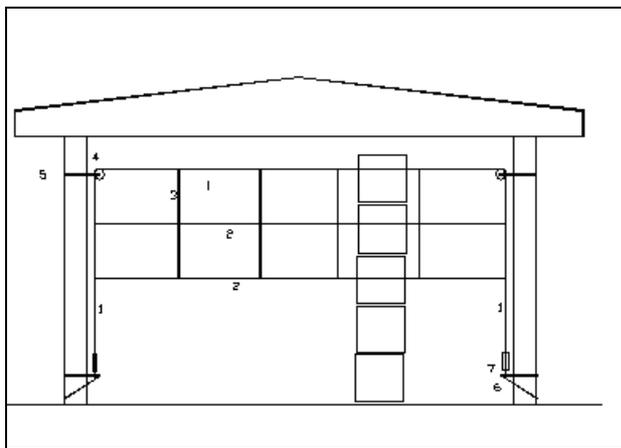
Schema tipo del sistema elastico di contenimento delle rotoballe
